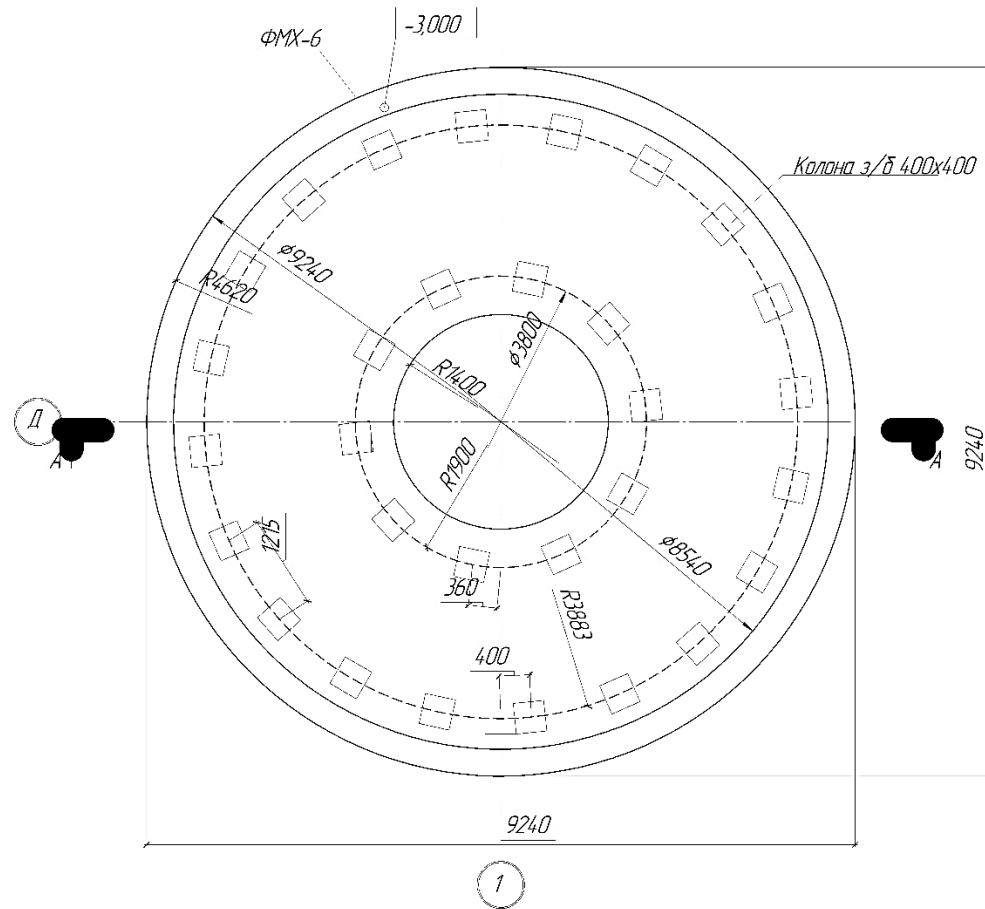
План нижньої фундаментної плити на відмітці -3.500
